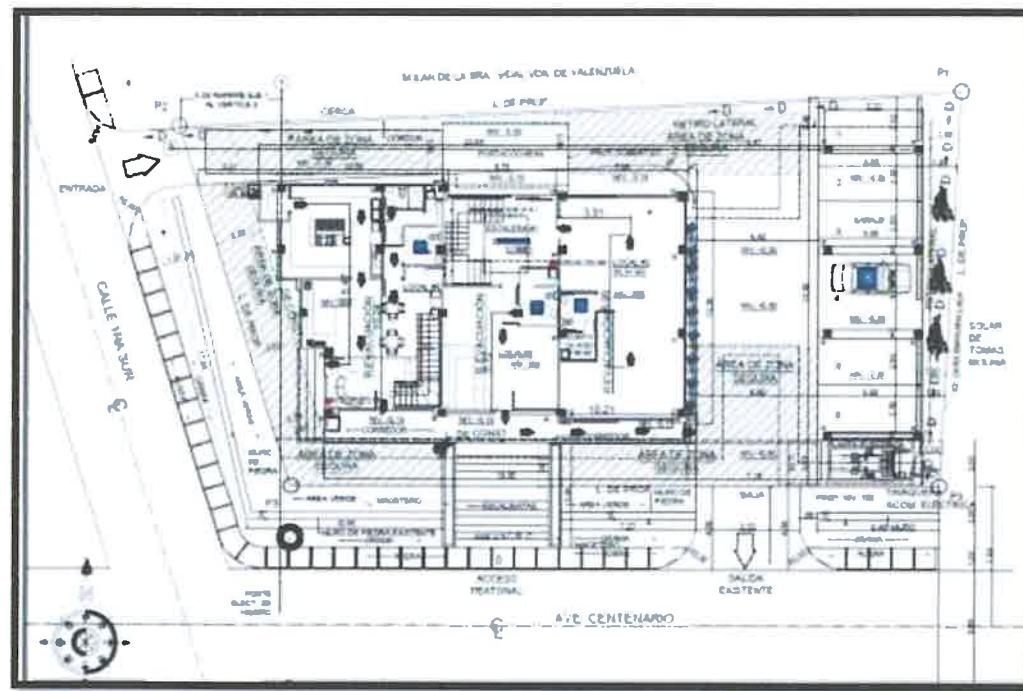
Calles que colindan con el proyecto, donde se descargarán las aguas pluviales del proyecto.
